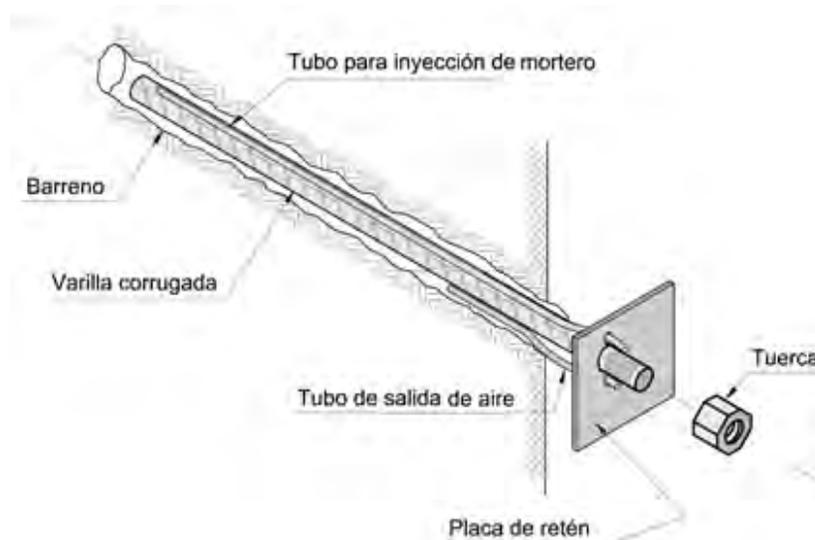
Esquema típico de anclaje pasivo con fijación química mediante lechada de cemento.
